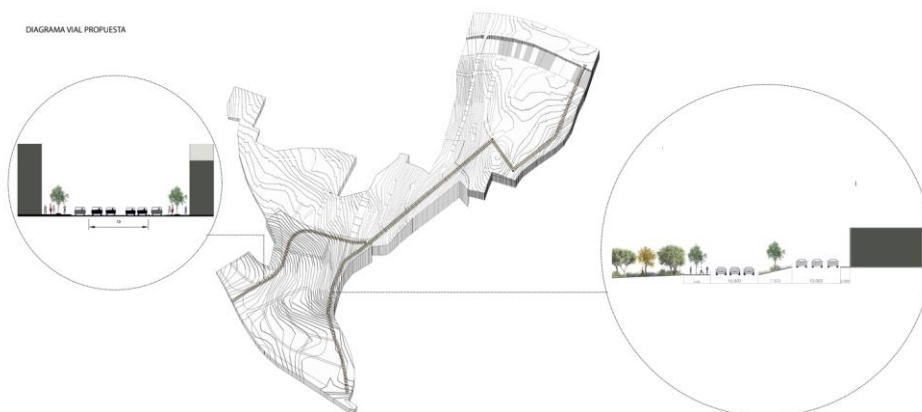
Sección de la propuesta vial. Elaboración grupal.
